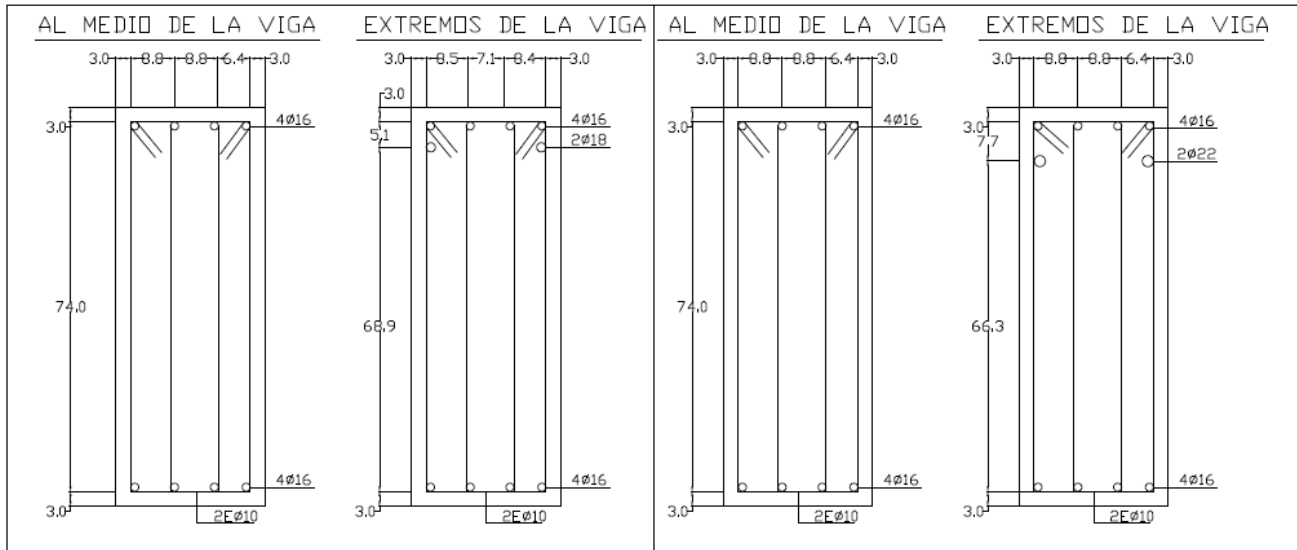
Sección transversal de las vigas del piso 3 de la estructura aislada
